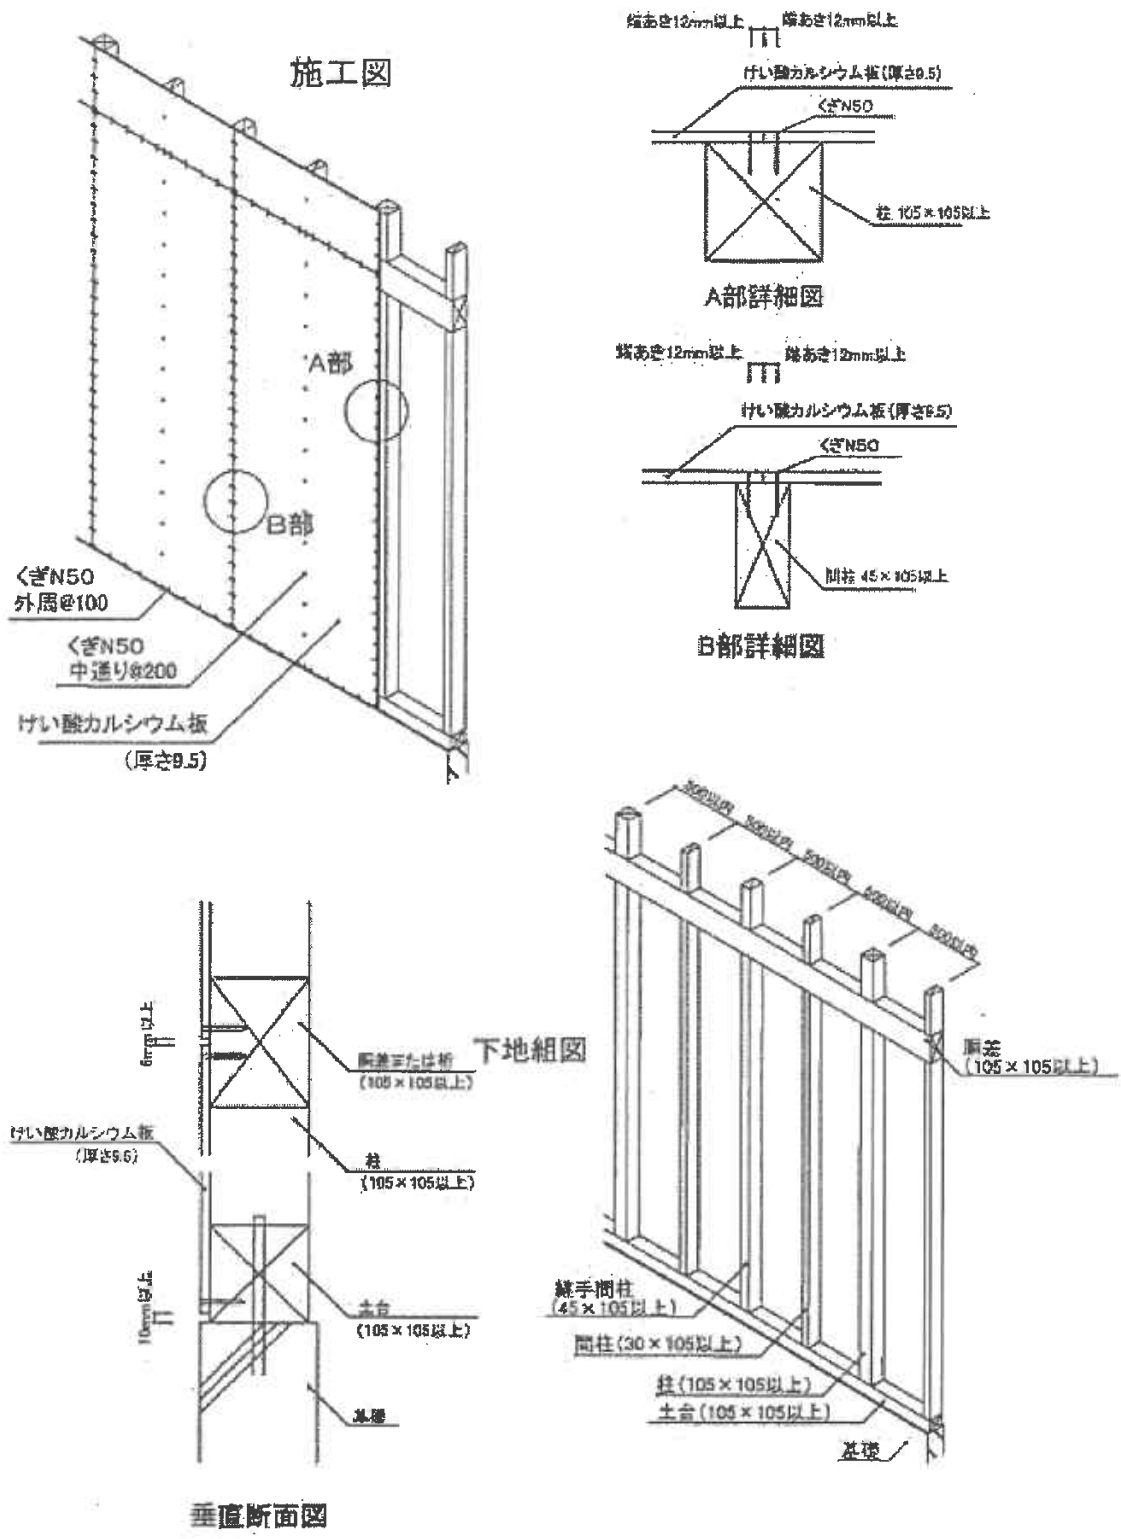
施工図：継手を設けない場合（寸法単位：mm）
